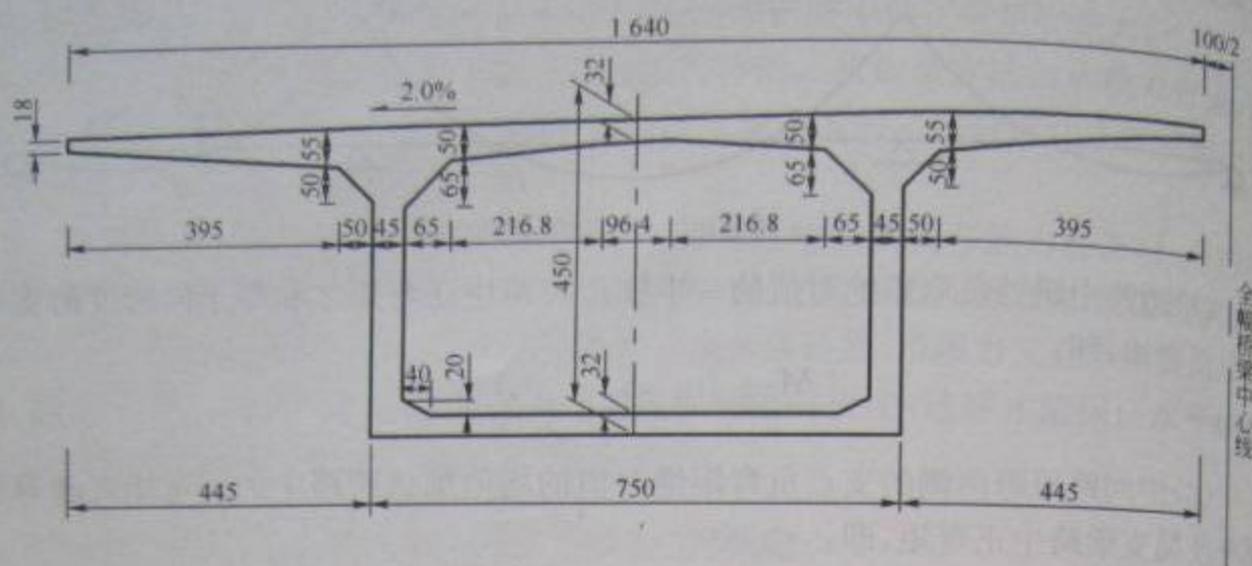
苏通大桥辅桥主桥跨中截面(尺寸单位:cm)
